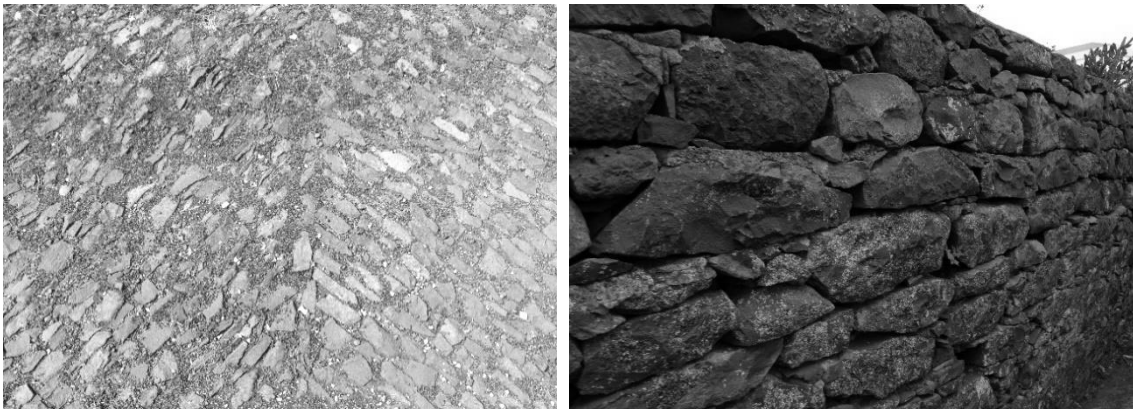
Fotos da calçada e parede de pedra basáltica da propriedade. (Foto de autor)
